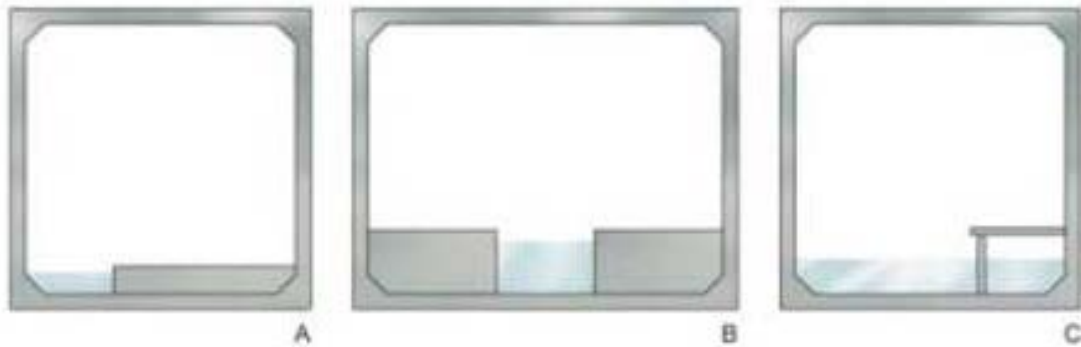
Distintas alternativas de diseño para facilitar pasos secos en drenajes. A. Drenaje con zanja lateral. B. Drenaje con zanja central. C. Drenaje con banquetta lateral. (Fuente: http://terexserver.net/movil/source_Ayuda_GSM/Fichas/03%20-%20Entorno/PAFA.htm).
